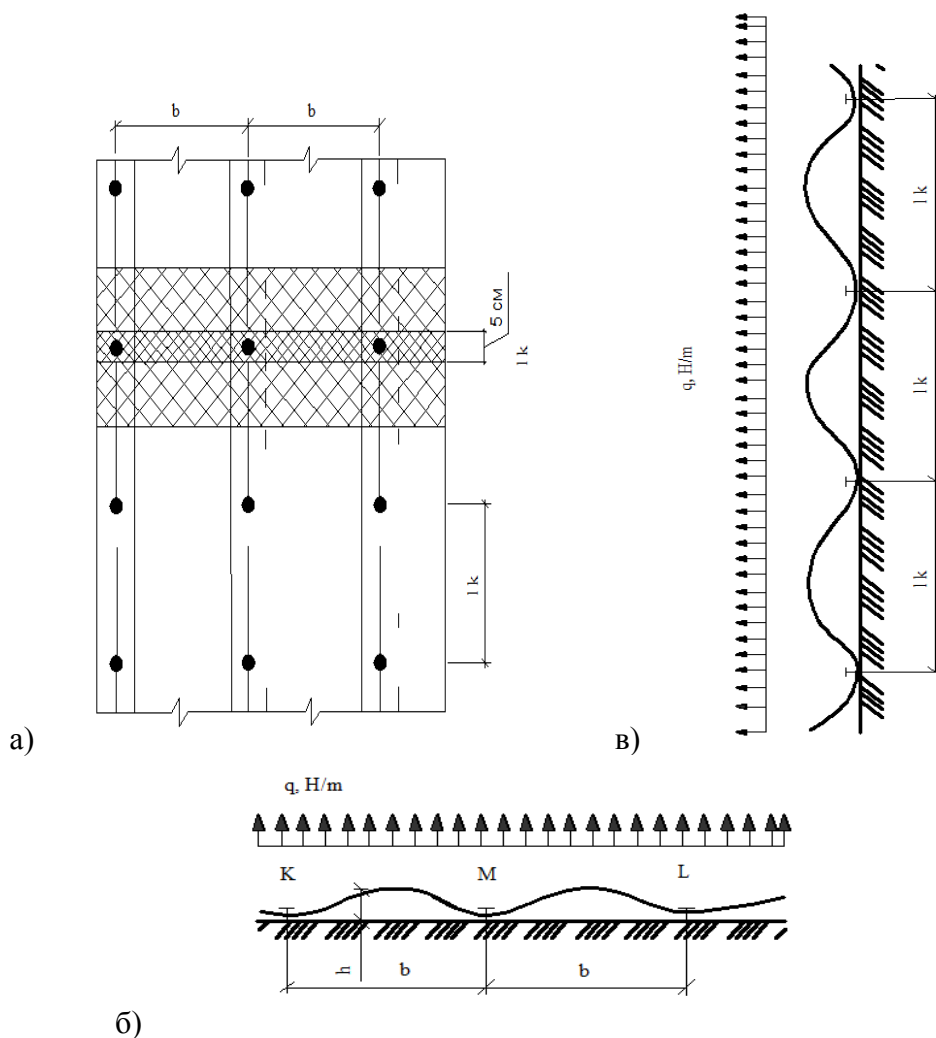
План участка кровельного ковра (а) и схема деформирования ковра (б и в)
